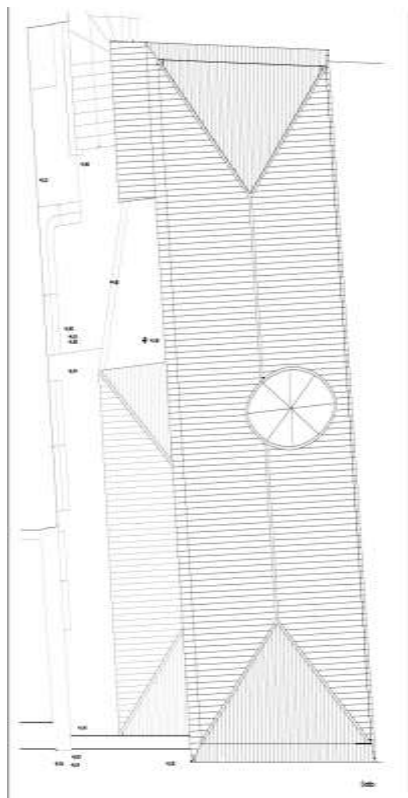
Planta cobertura do Edifício Ponte Nova (Retirado de [41]).
